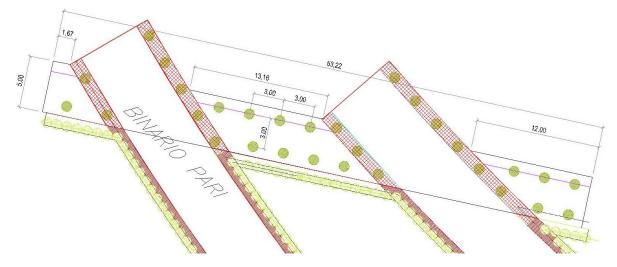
Pianta dei manufatti oggetto della presente relazione di calcolo.
